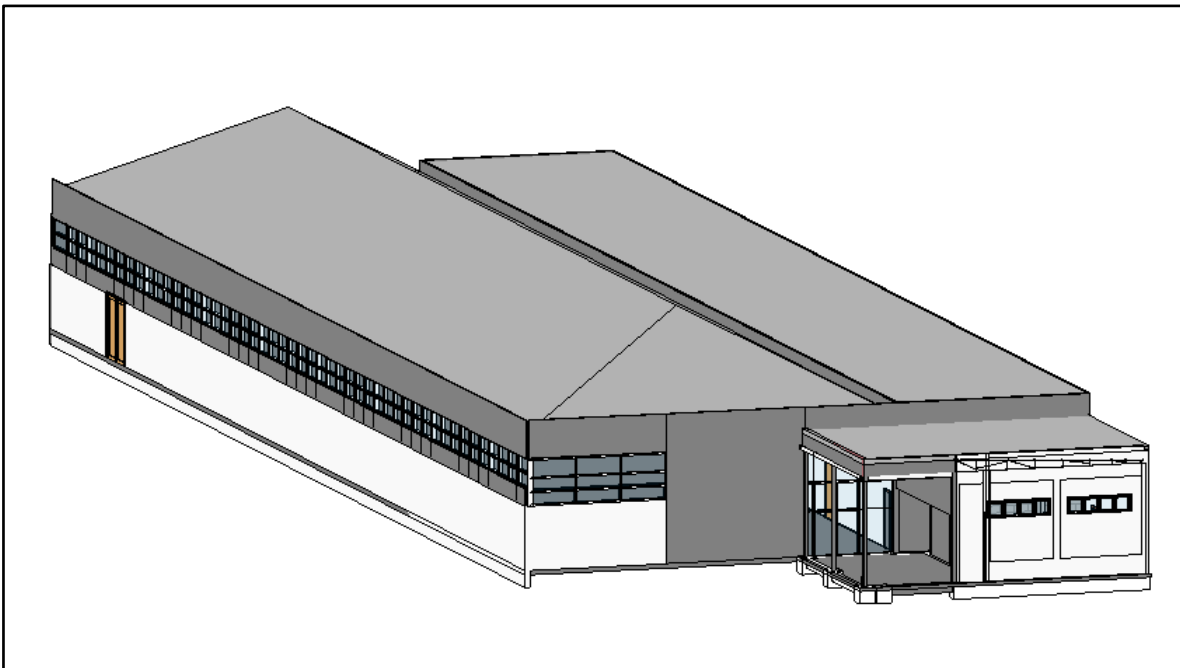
Vinculación proyecto de arquitectura con estructura.
